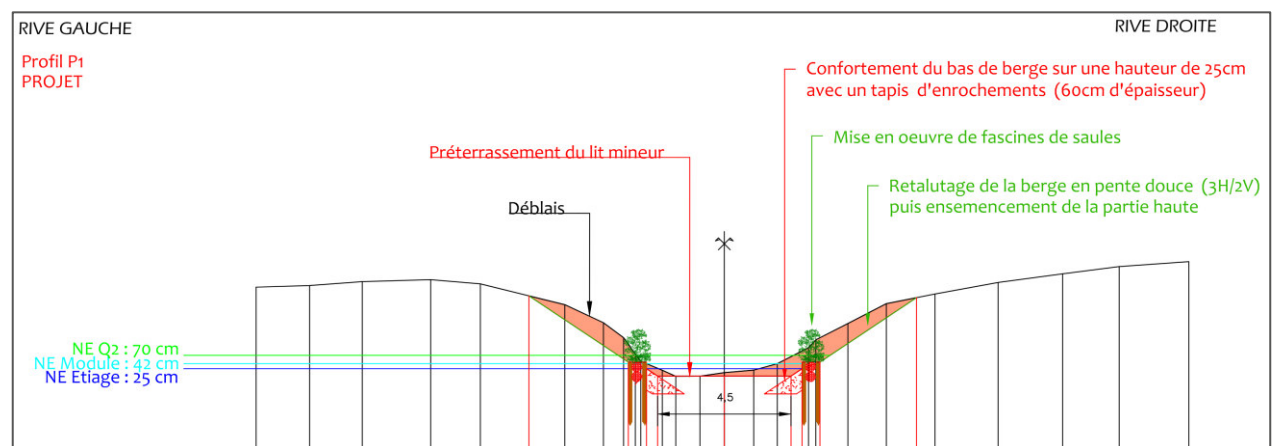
Profil en travers type appliqué au site en amont de l'ouvrage
